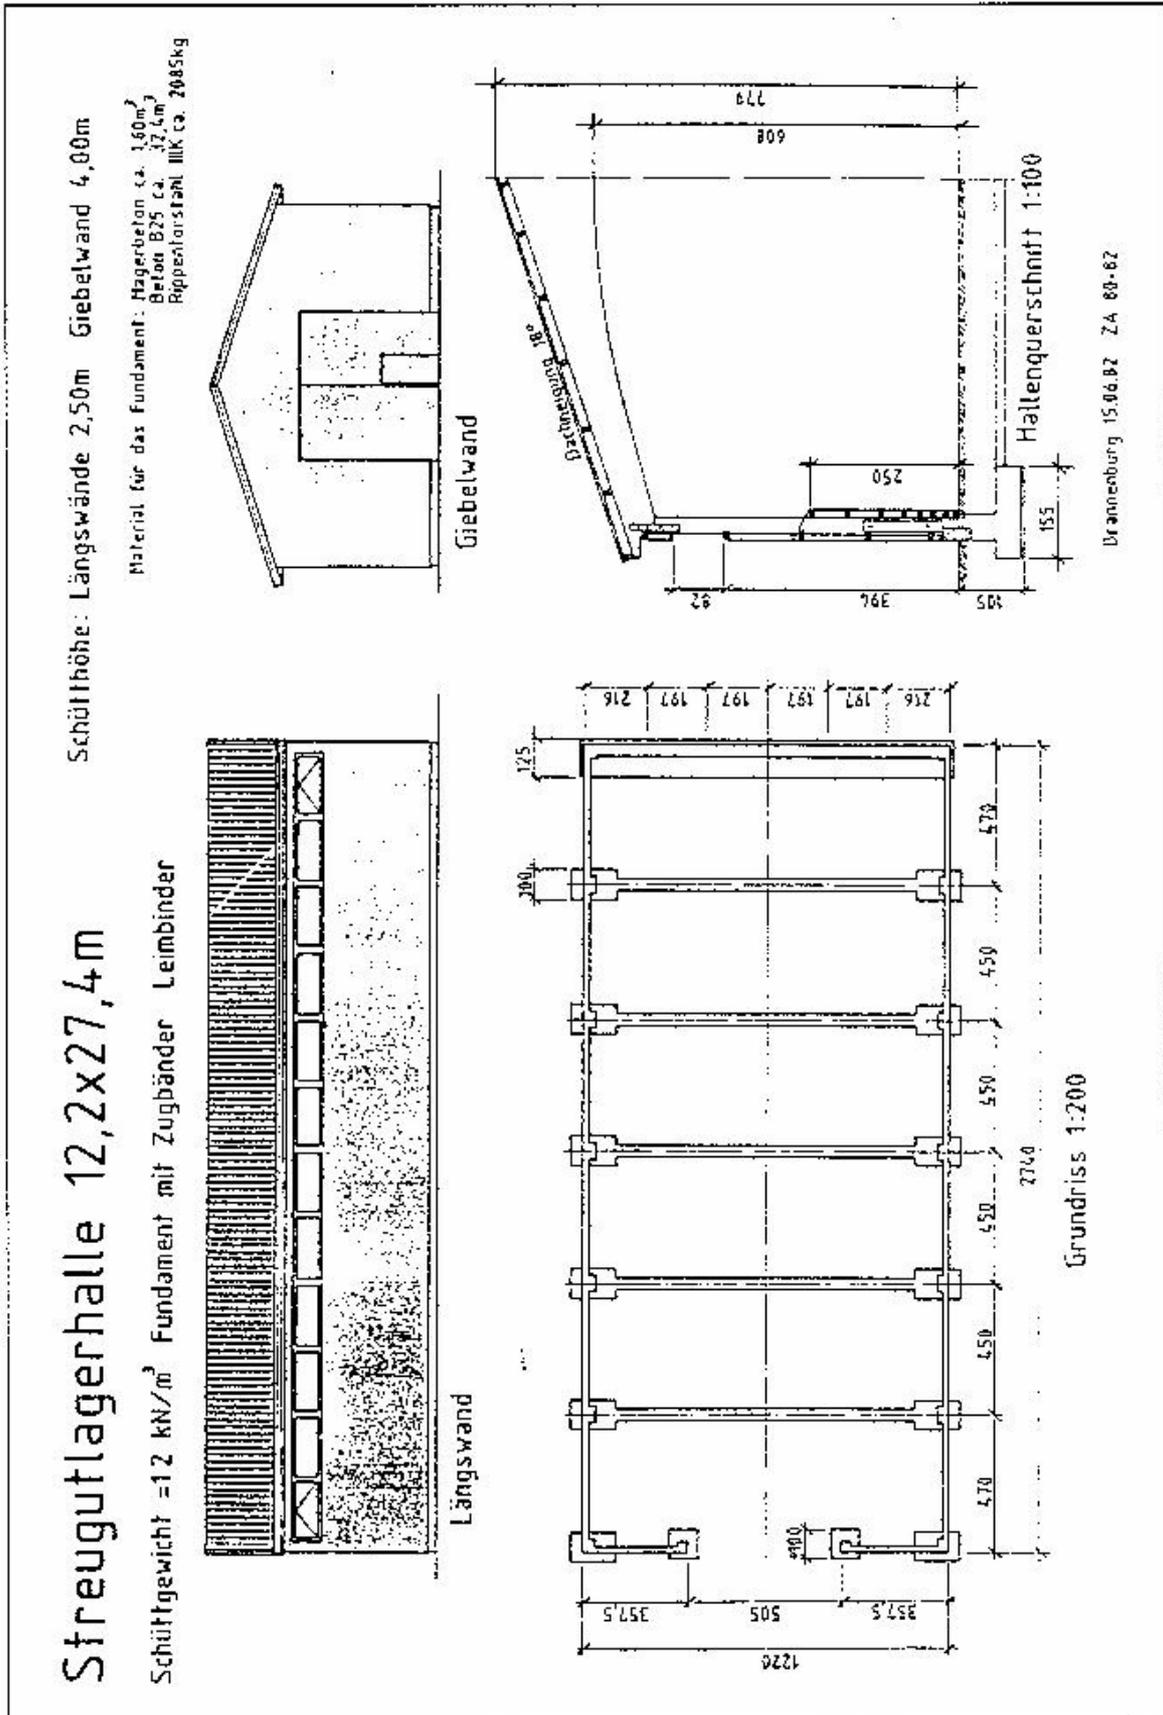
Streugutlagerhalle (Werkbild Holzbau Holten)
